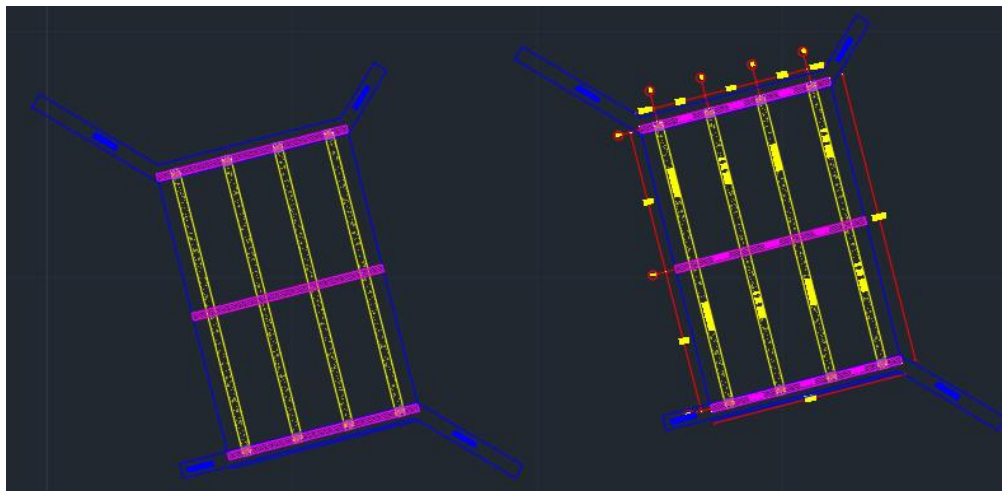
Puente 1 San Andrés de Pisimbalá – Planta y Perfil
